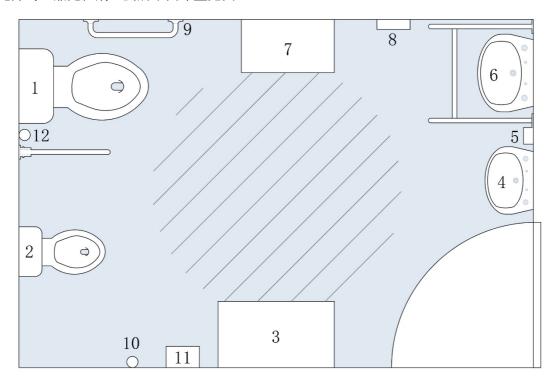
无障碍(兼无性别)厕所平面布置示意图
